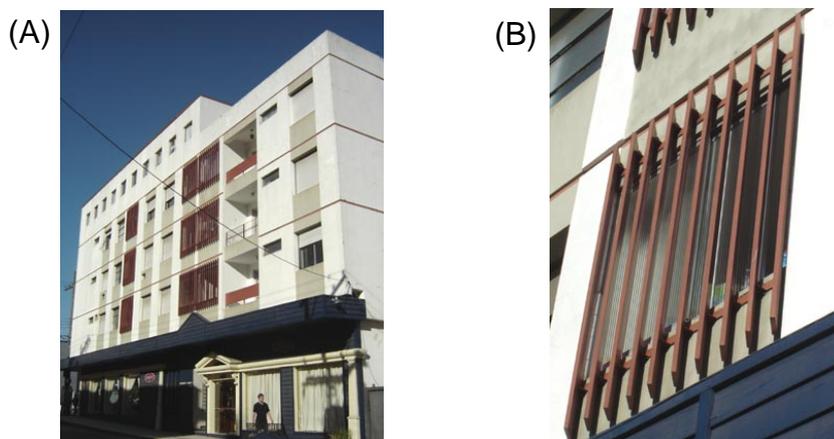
Vistas externas – (A) fachada Leste (B) detalhe dos *brises* verticais fixos
